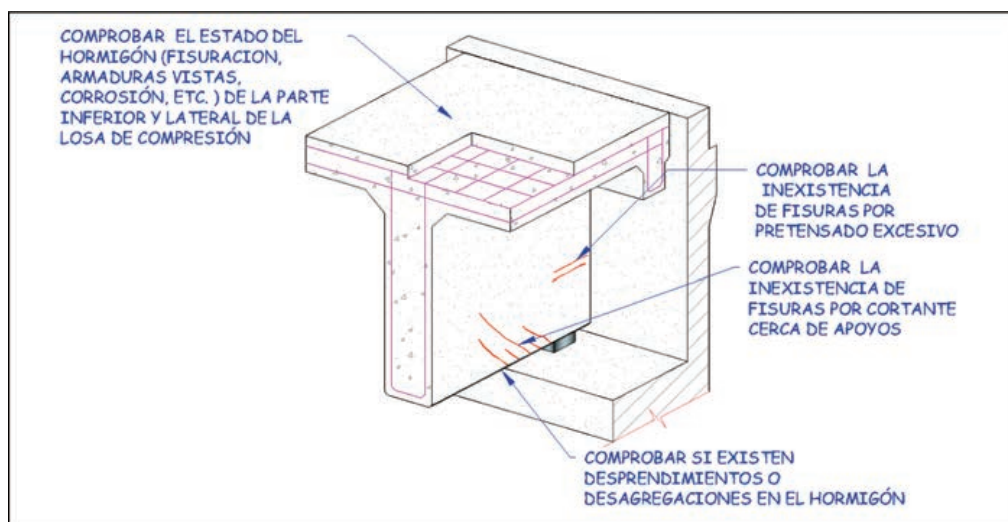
ALGUNOS DE LOS ASPECTOS BÁSICOS A COMPROBAR EN UN TABLERO DE VIGAS DE HORMIGÓN.
